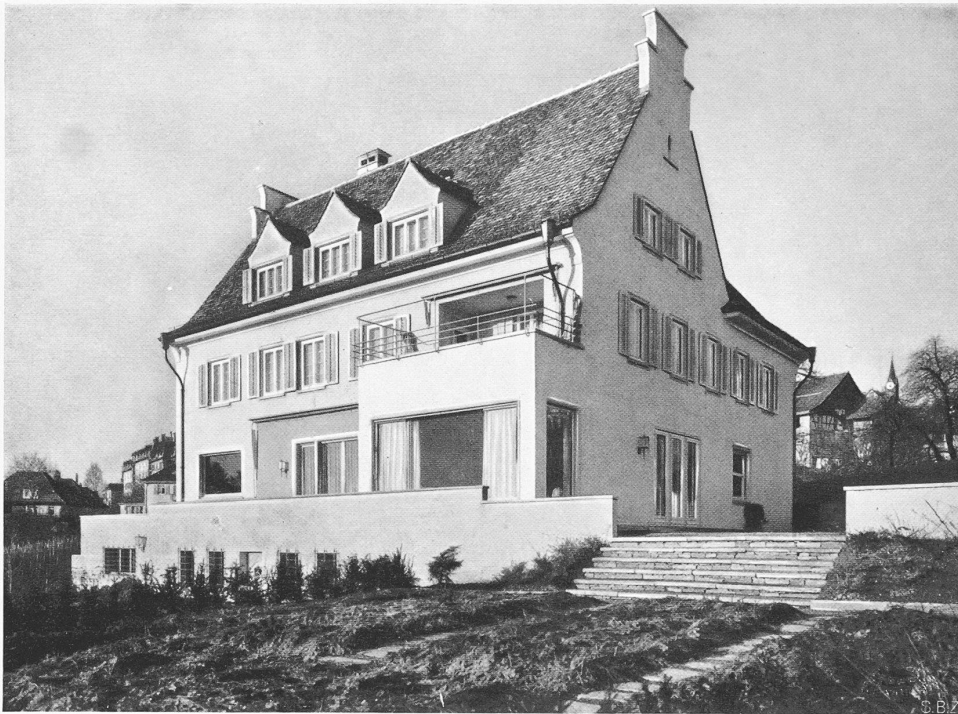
bis 4. Wohnhaus Werner Bär. — Arch. Otto Honegger, Zürich. — Grundrisse 1 : 400.
